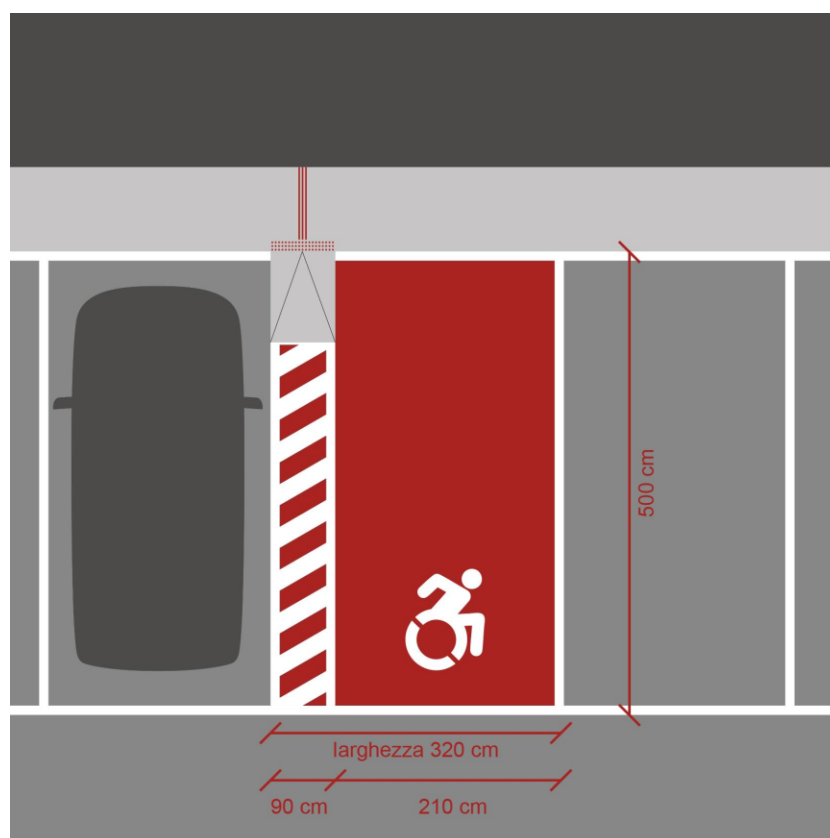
Schema planimetrico che illustra la progettazione di un parcheggio perpendicolare accessibile per persone con disabilità, con le dimensioni minime richieste. Evidenzia inoltre la necessità di un collegamento sicuro al marciapiede, tramite una rampa, e la presenza di pavimentazione tattile per facilitare l'identificazione del posto auto riservato da parte di tutti gli utenti (Opera degli autori).
